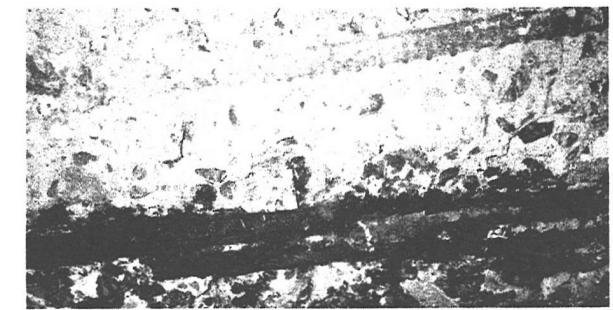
ひび割れの原因推定のイメージ(2)
